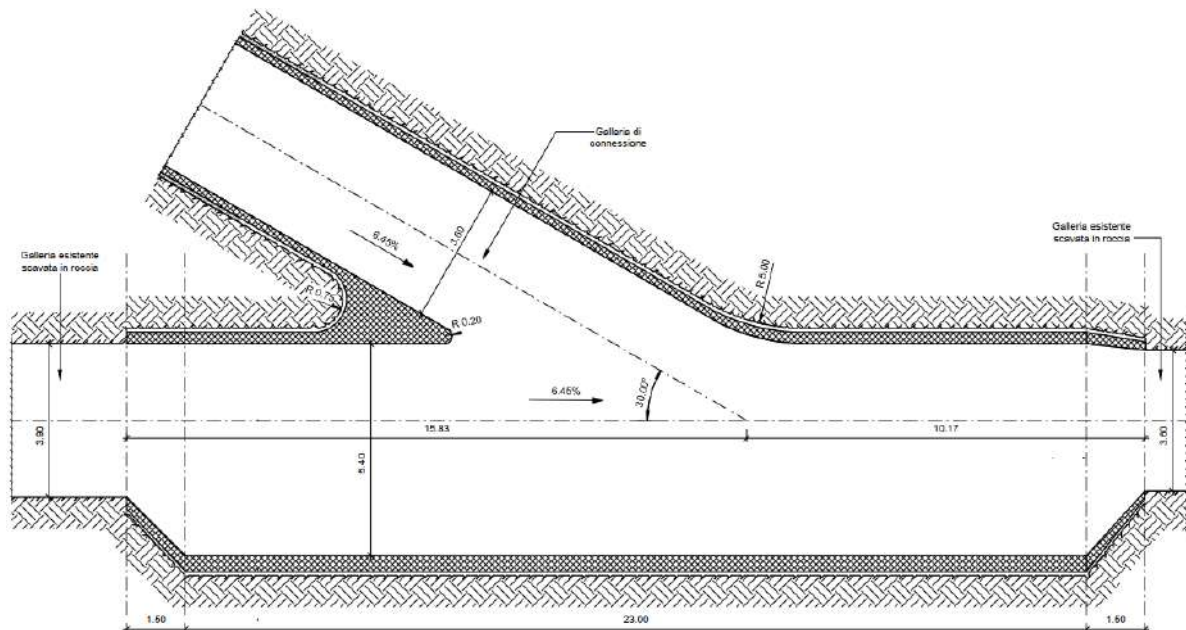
Nicchia realizzata nel paramento in destra e nella pavimentazione (vista in pianta)
